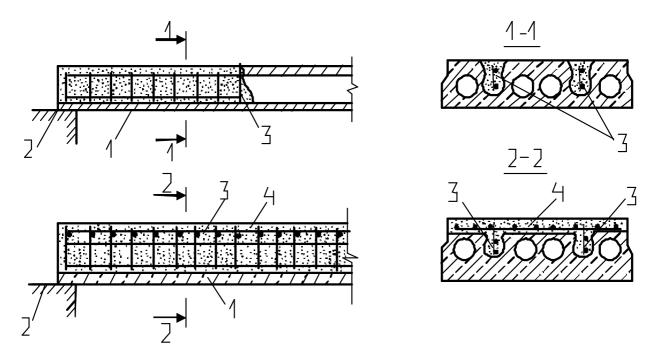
Усиление сборных многопустотных плит перекрытия: 1 – усиливаемая плита; 2 – опора; 3 – дополнительный арматурный каркас; 4 – бетон усиления
